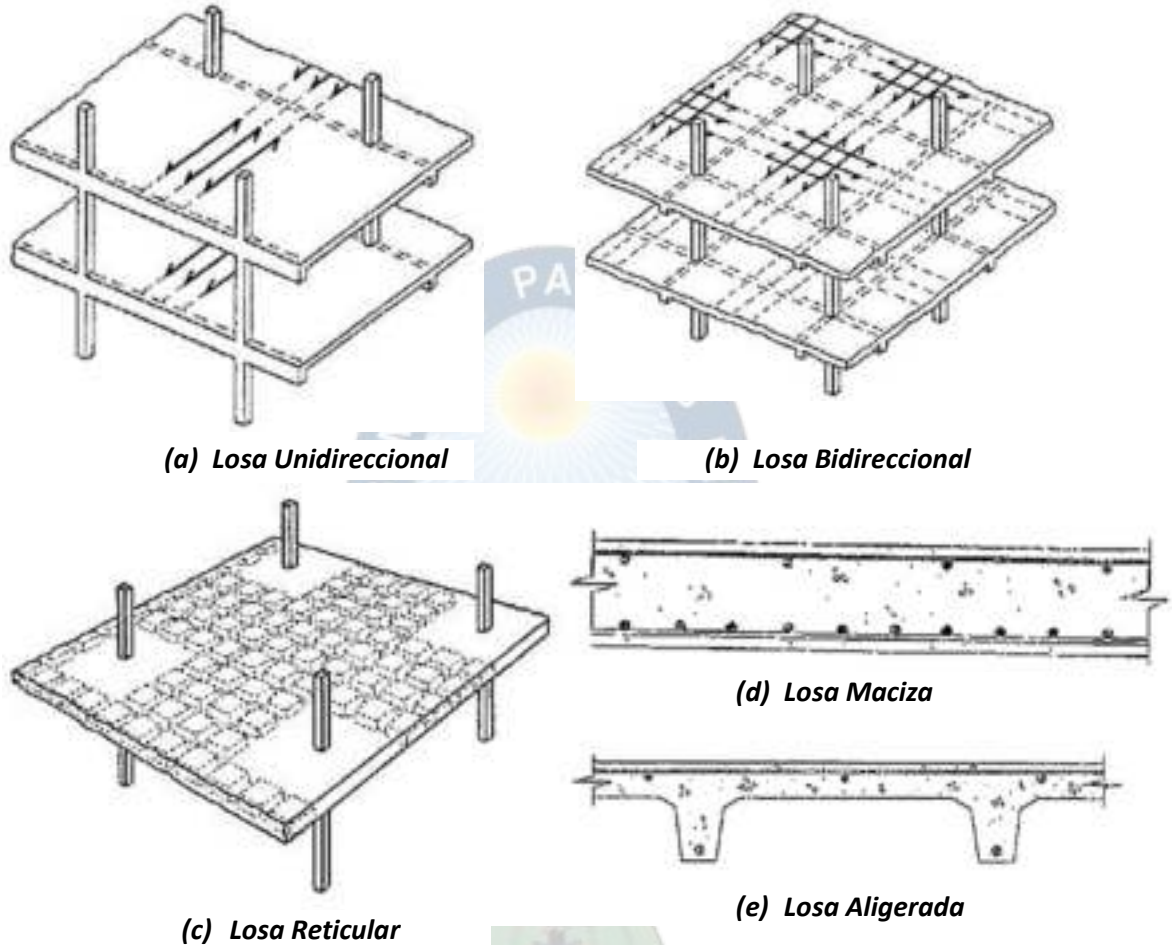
Elementos que conforman una estructura de Hormigón Armado
